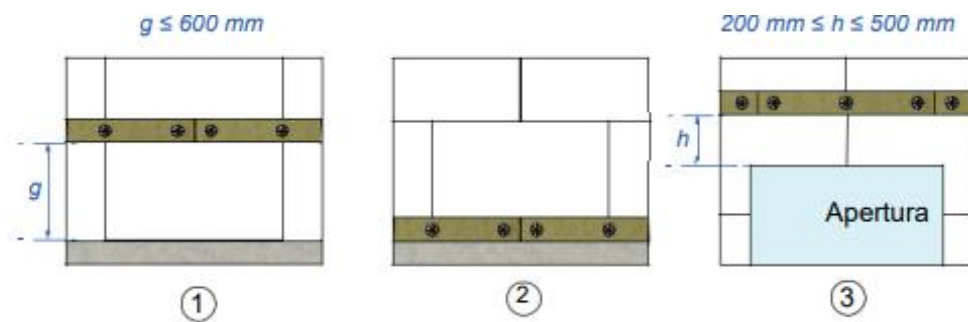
Soluzione A - Disposizione strisce in facciata
